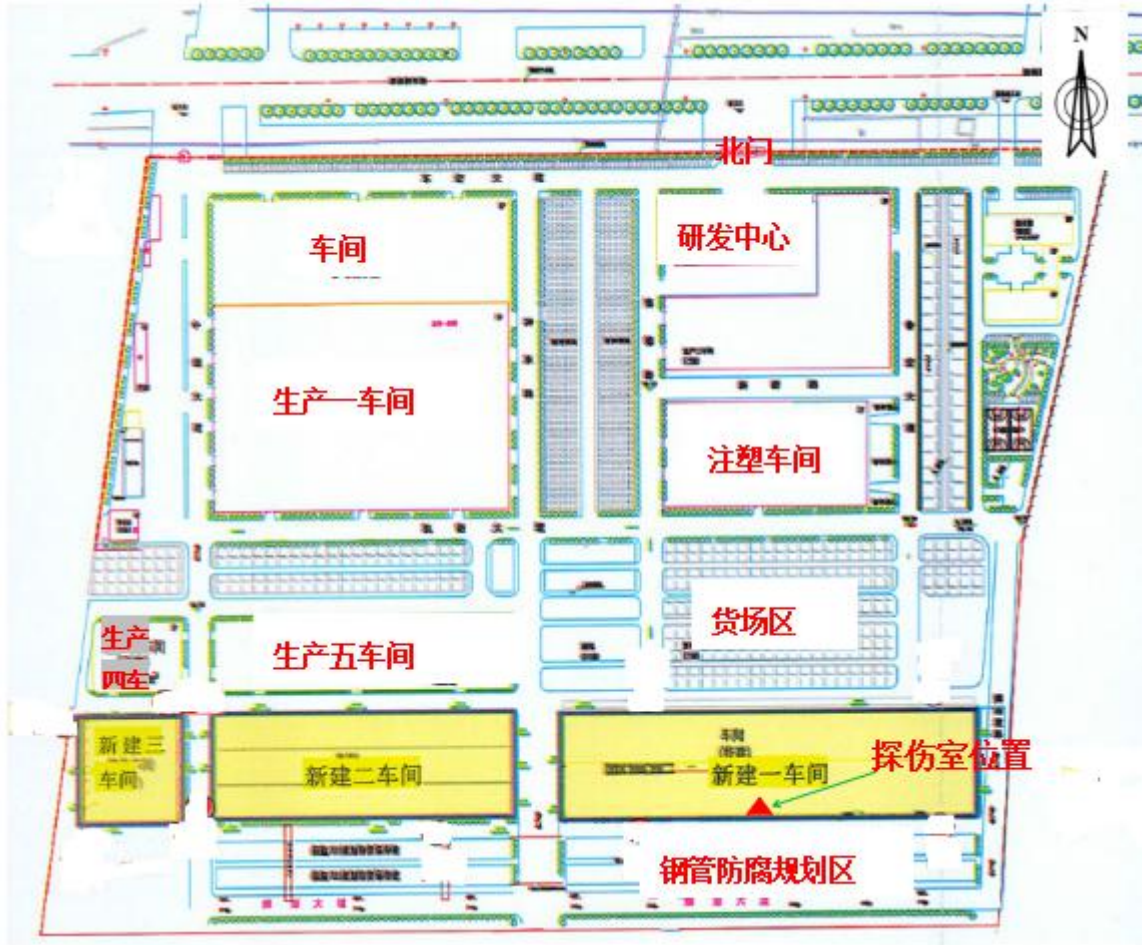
山东东宏管业股份有限公司南厂区平面图布置图
